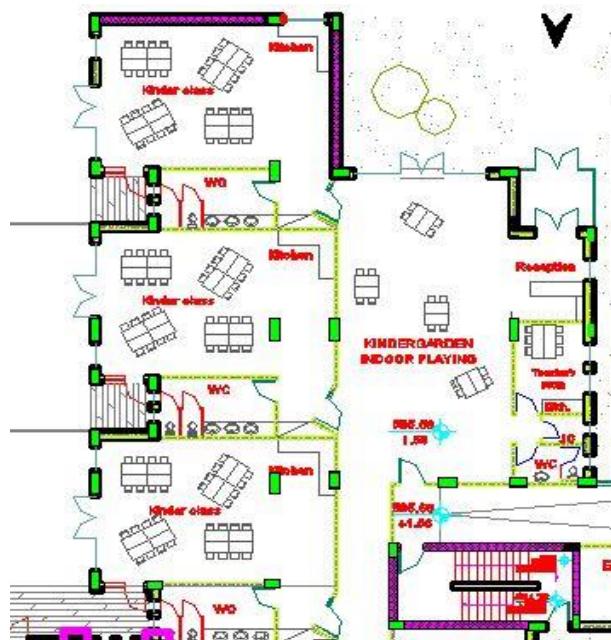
مسقٍ طابق التسوية الأول الجزء الثالث.
